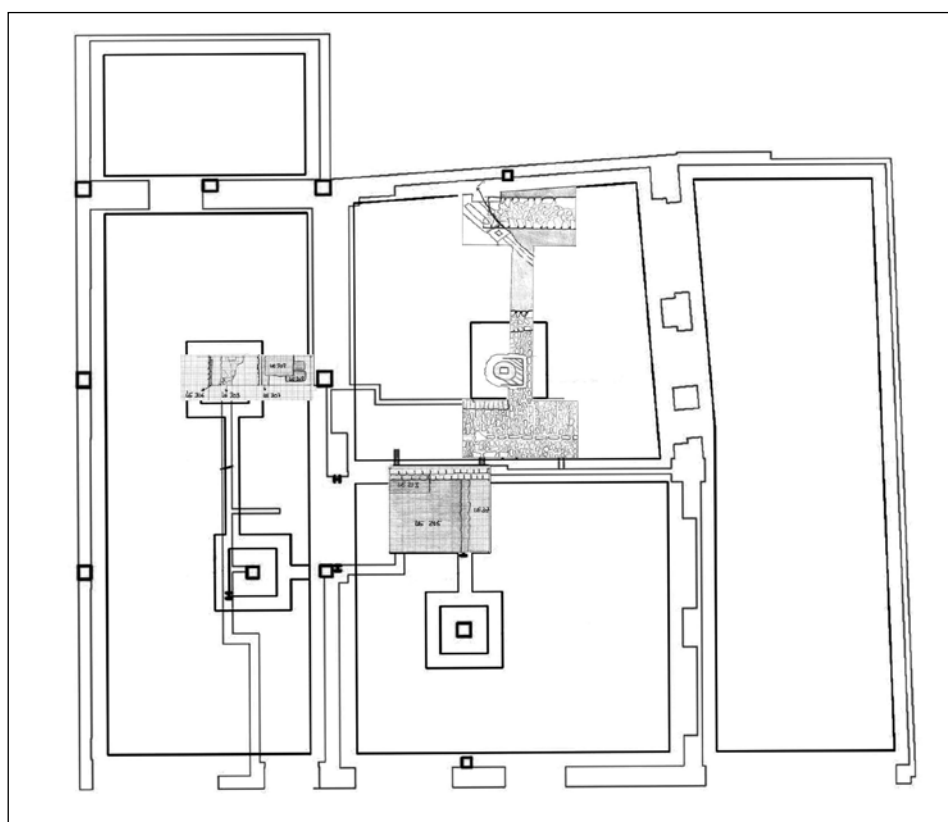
Pamplona. Plano de la excavación de las zapatas de cimentación y refuerzo. El hallazgo de la lámpara ritual se produjo en el lado norte de la zanja nº 1.
